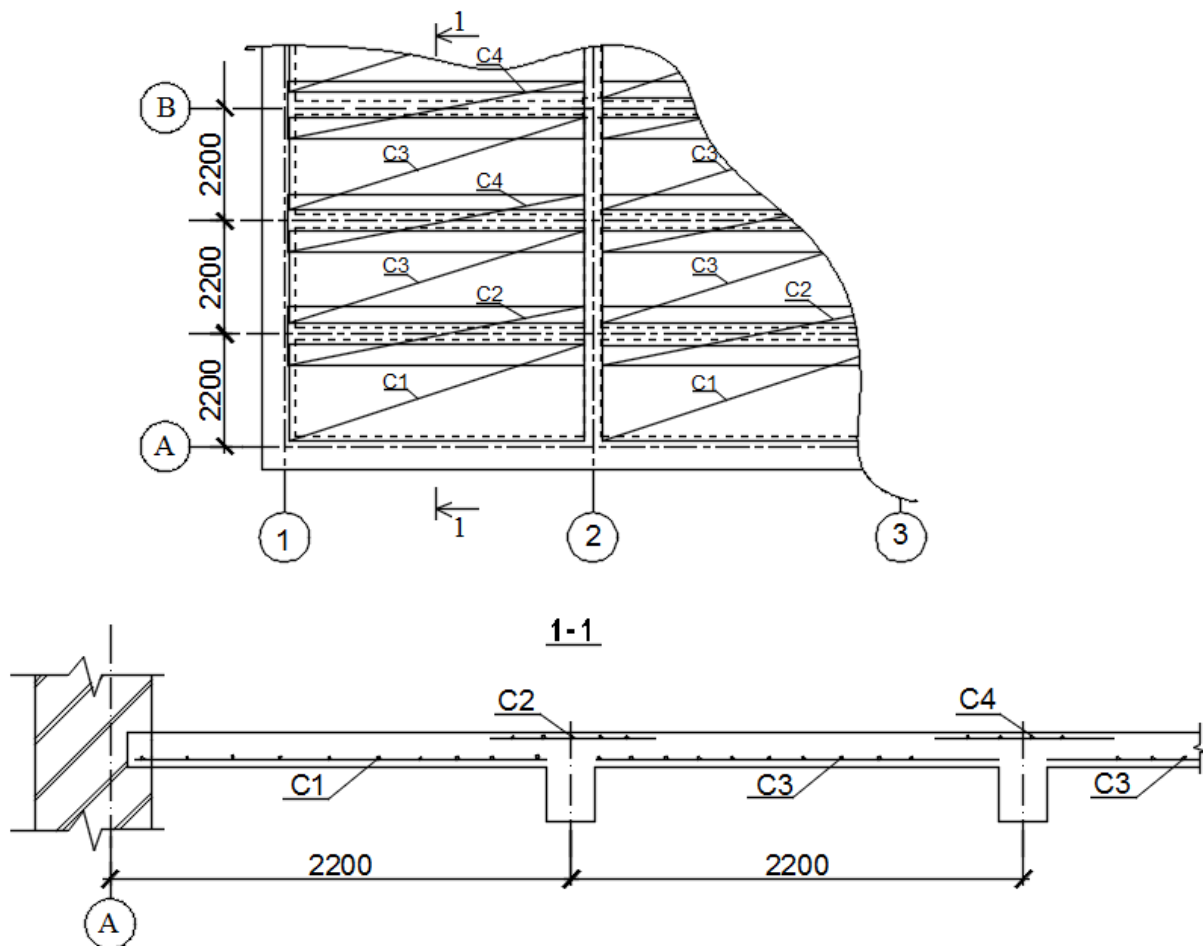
Фрагмент схеми армування роздільним способом
